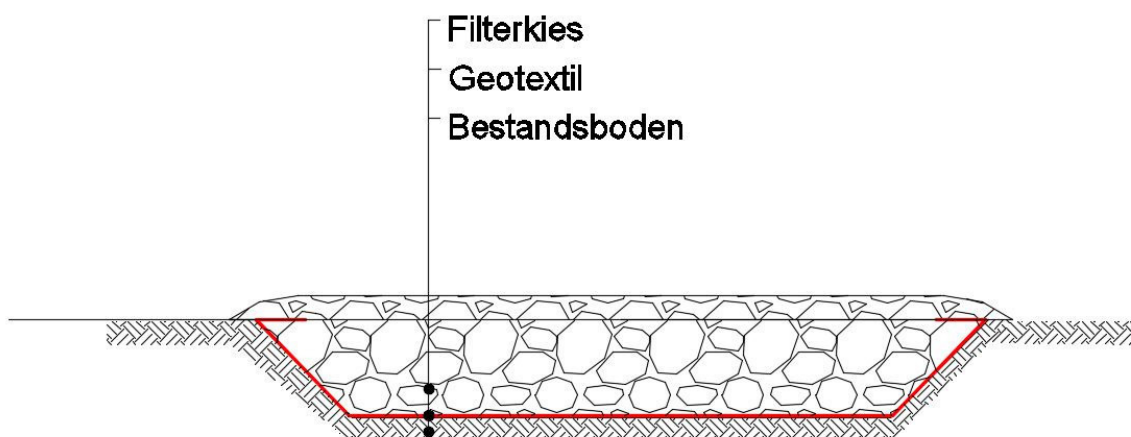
Schematischer Schnitt durch die Baustraße mit Rigolenunterbau
